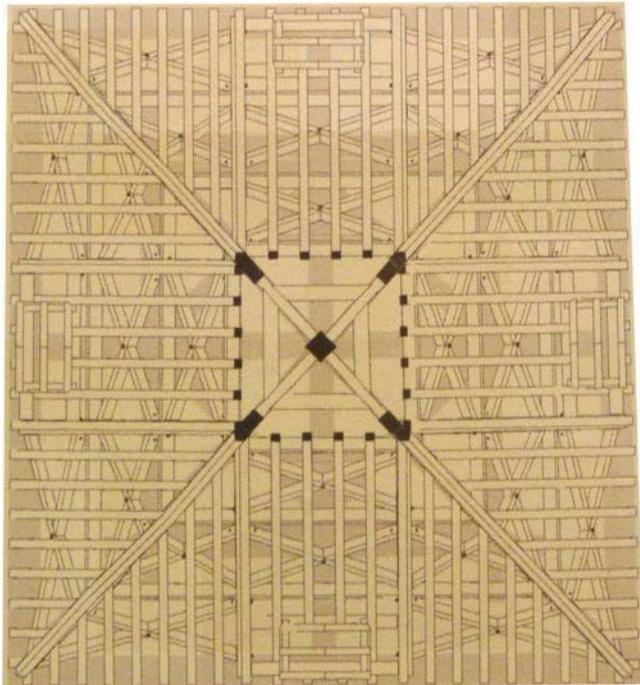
sección horizontal sobre el tercer entramado de la armadura. Idem anterior
